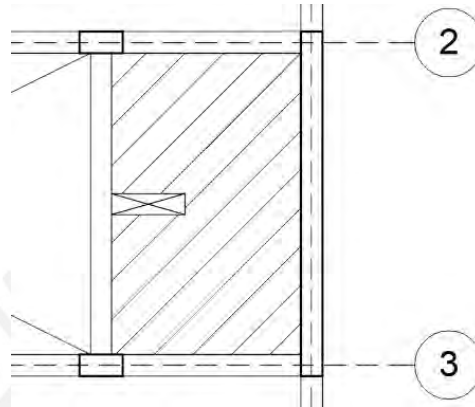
10. Ubicación de losa maciza en el encofrado de techo típico
